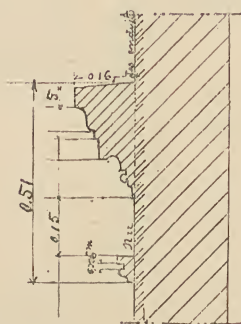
Profil du bandeau de couronnement de la façade sur cour.
